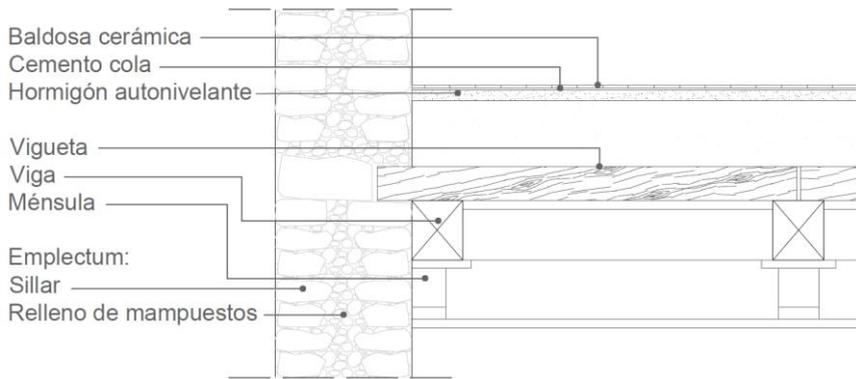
Detalle constructivo de la unión de un tipo de forjado con el muro.
